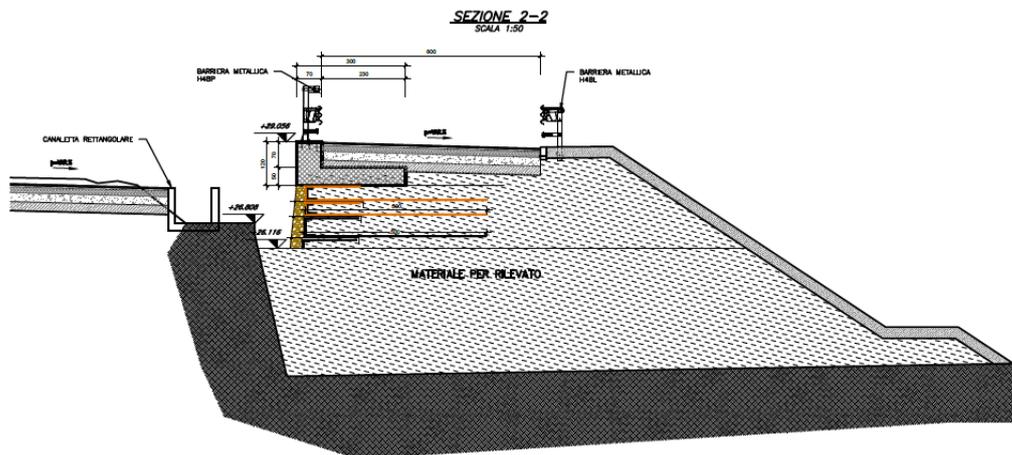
sezione trasversale muro di sostegno in terra armata sez 2-2
